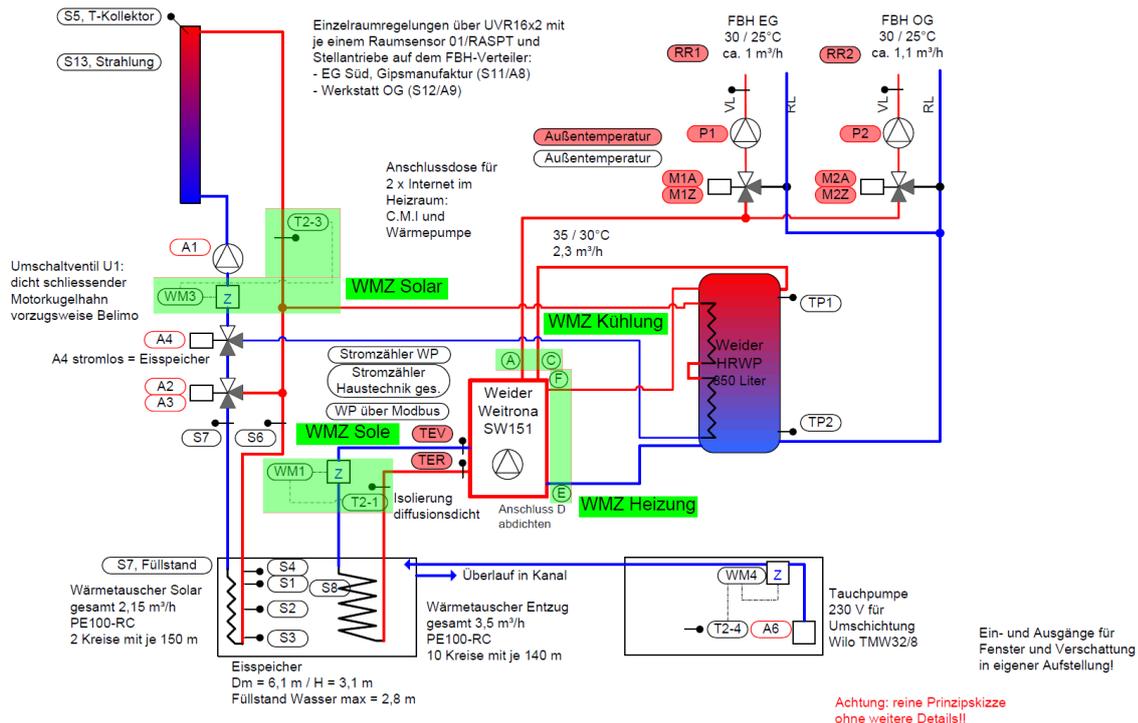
Prinzipskizze Haustechniksystem mit Wärmemengenzähler in Grün [2]
